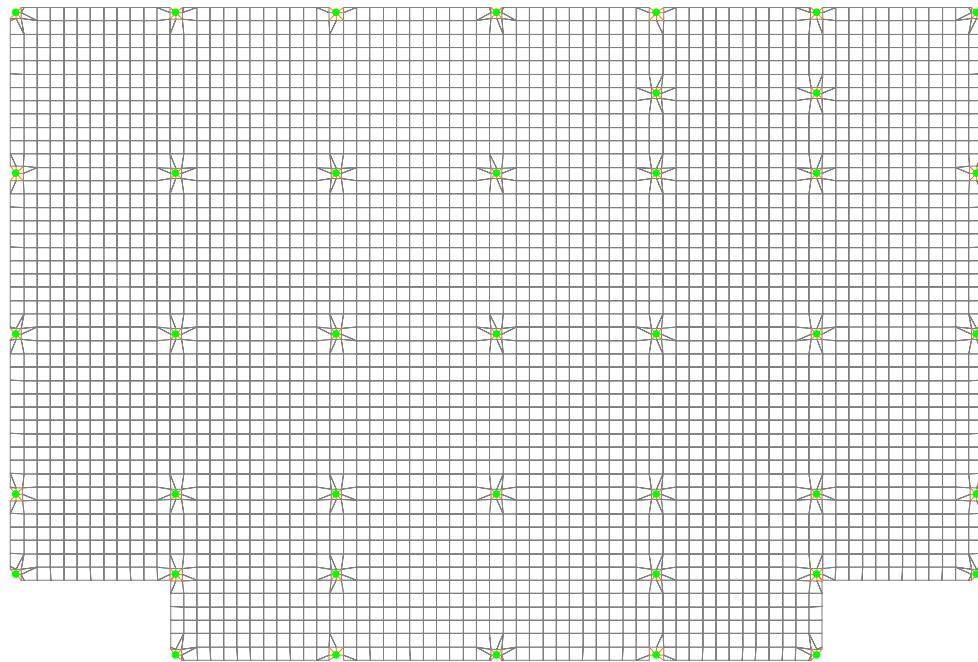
Схема монолитной плиты перекрытия подвала
